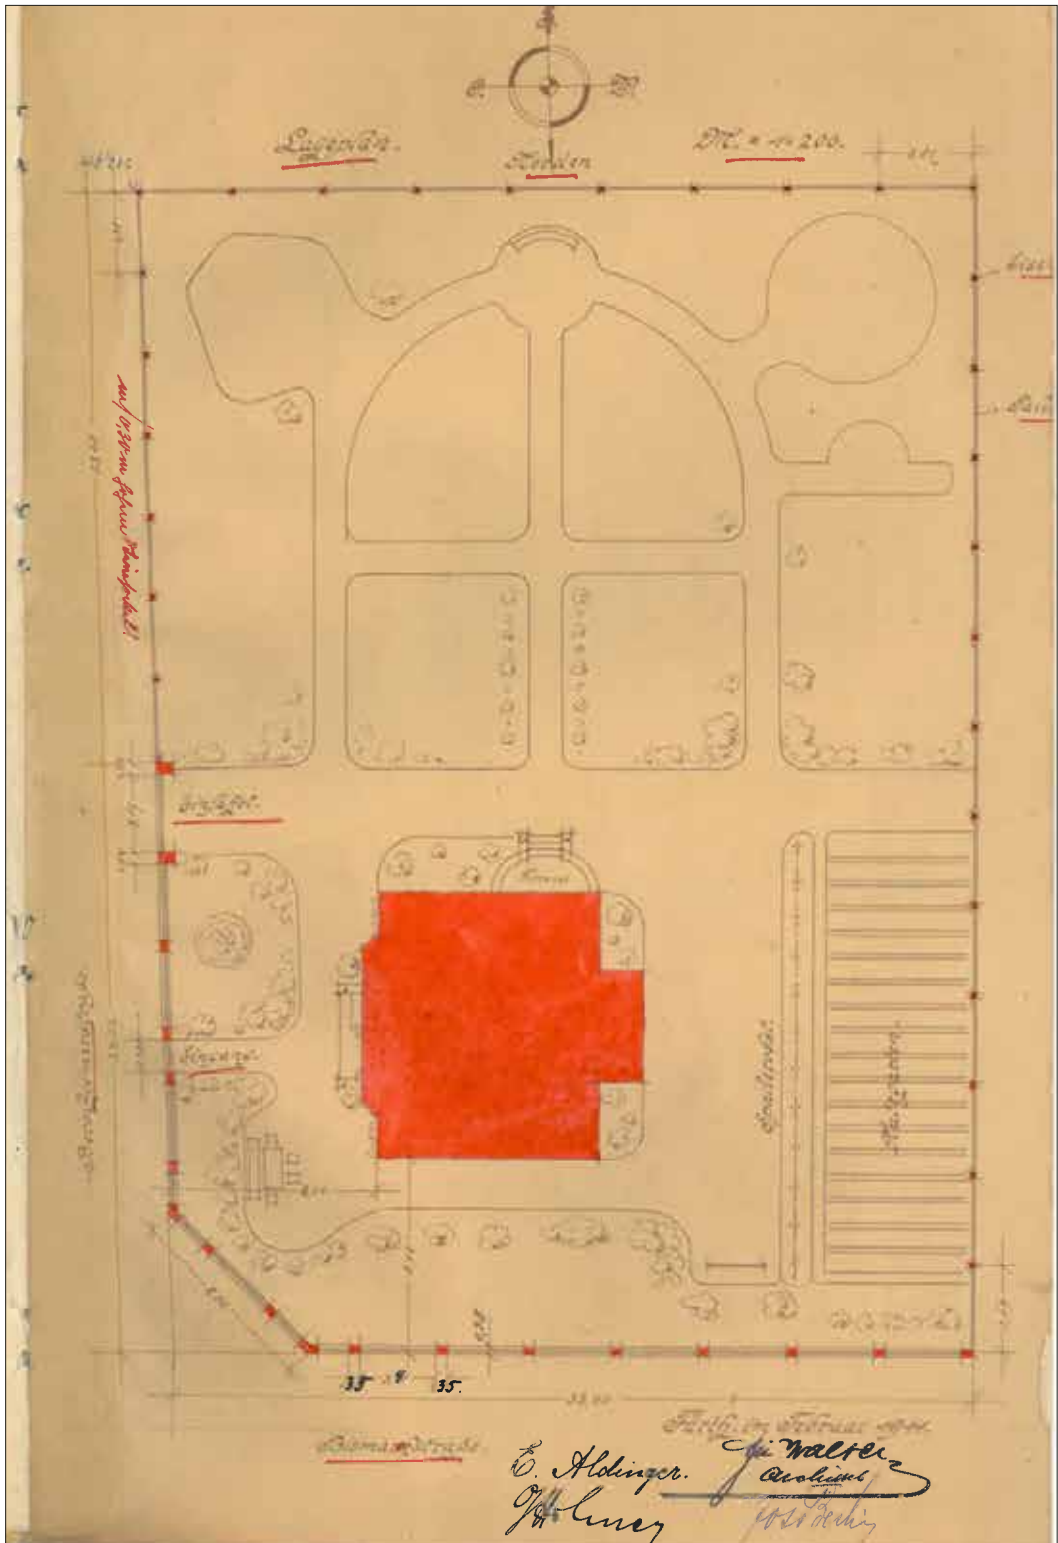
Lageplan der Villa Bismarckstraße 21, mit der Gartenanlage in Formen der landschaftlichen und geometrischen Gestaltung, 1911.
